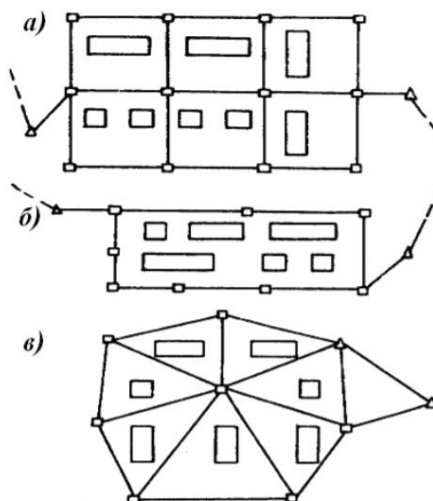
Схема создания плановой разбивочной сети строительной площадки
